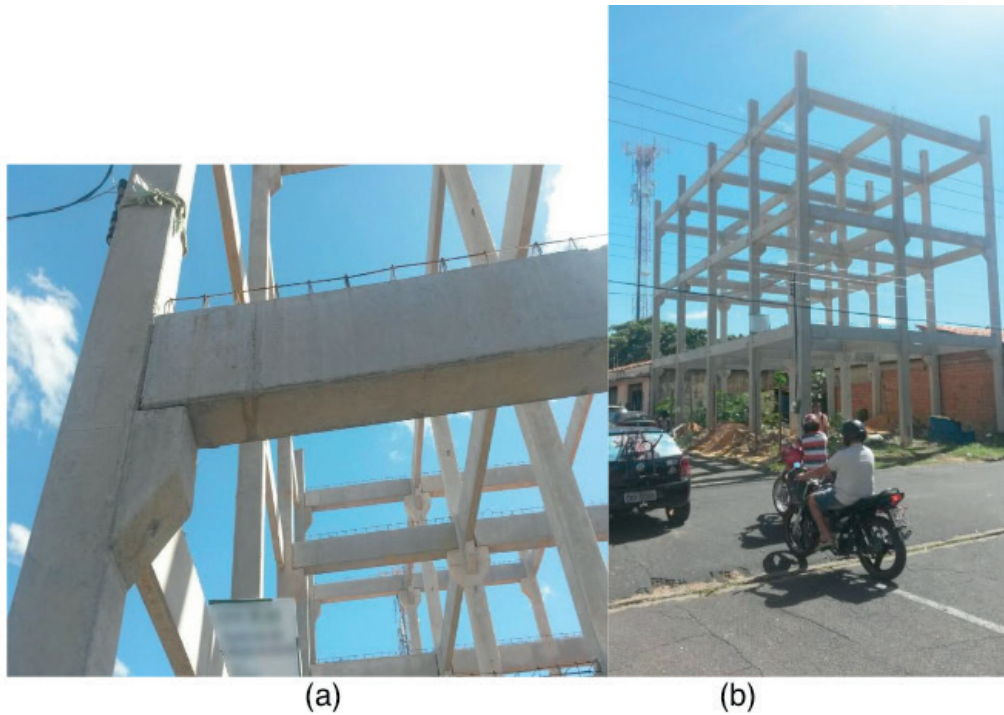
Peça com fissura, na fase de execução da estrutura (a) e Execução da montagem da estrutura(b) /
